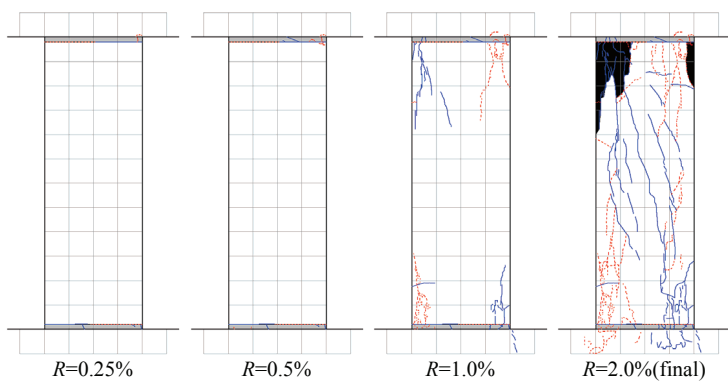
U1/2-0.2 ひび割れ状況
